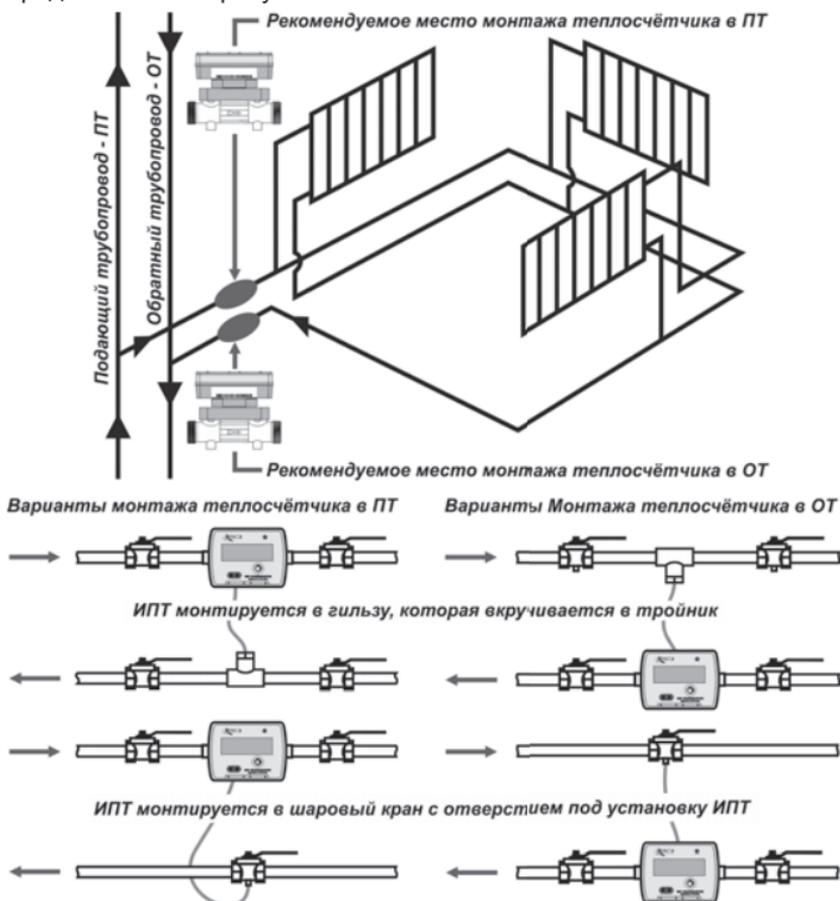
Рекомендуемые схемы монтажа в трубопровод
